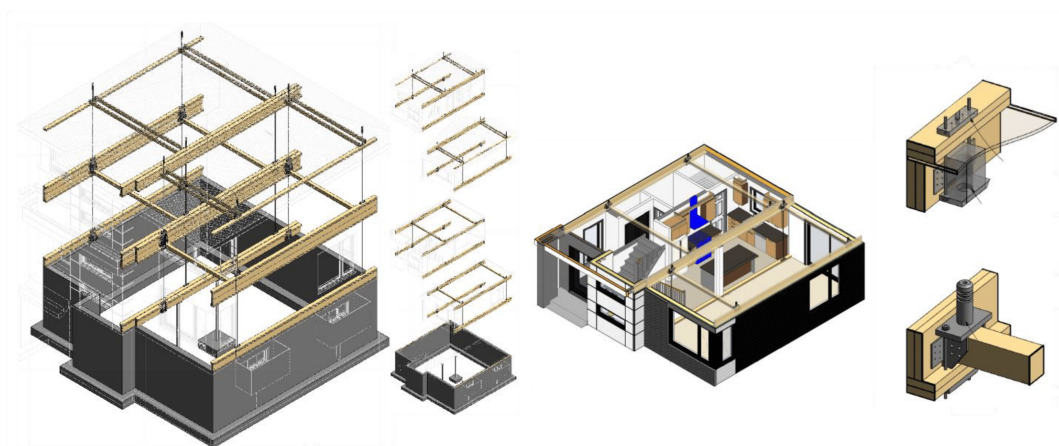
Sistema de construção modular *full scale* (tamanho real)
